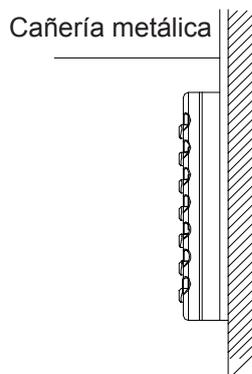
Montaje de superficie del cable Fig. 11.3 Montaje oculto de cable
